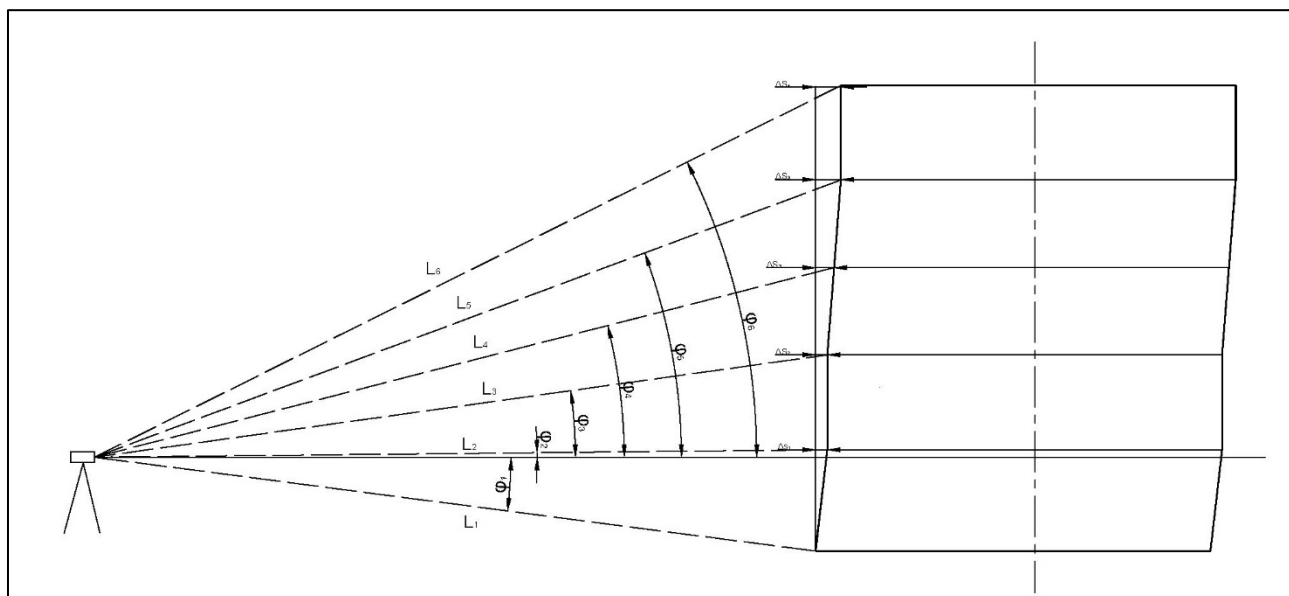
Схема измерений геометрической формы стенки резервуара (вид сбоку)
